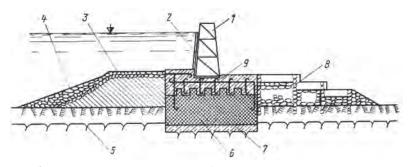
Водосливная плотина на р. Амазар: 1 — фермы Поарэ; 2 — щиты; 3 — фашинное крепление; 4 — крепление камнем; 5 — скала; 6 — каменная кладка; 7 — бетон; 8 — ряжи, загруженные камнем; 9 — железобетон
